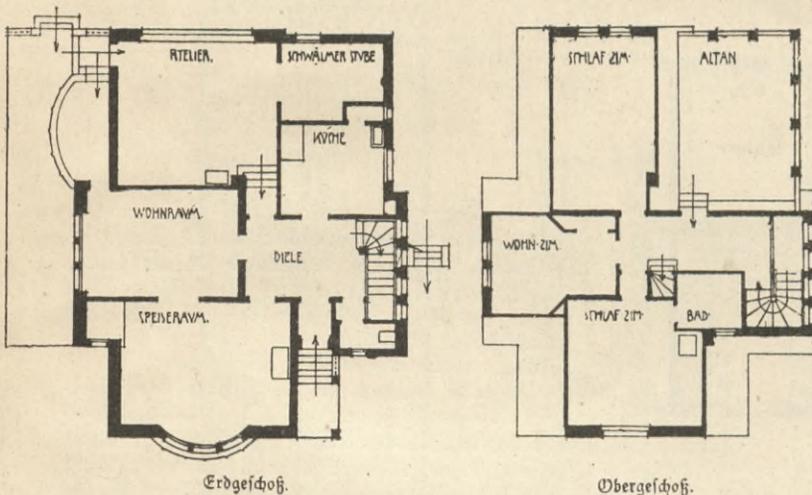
und 129. Landhaus Beithan in Buchschlag
